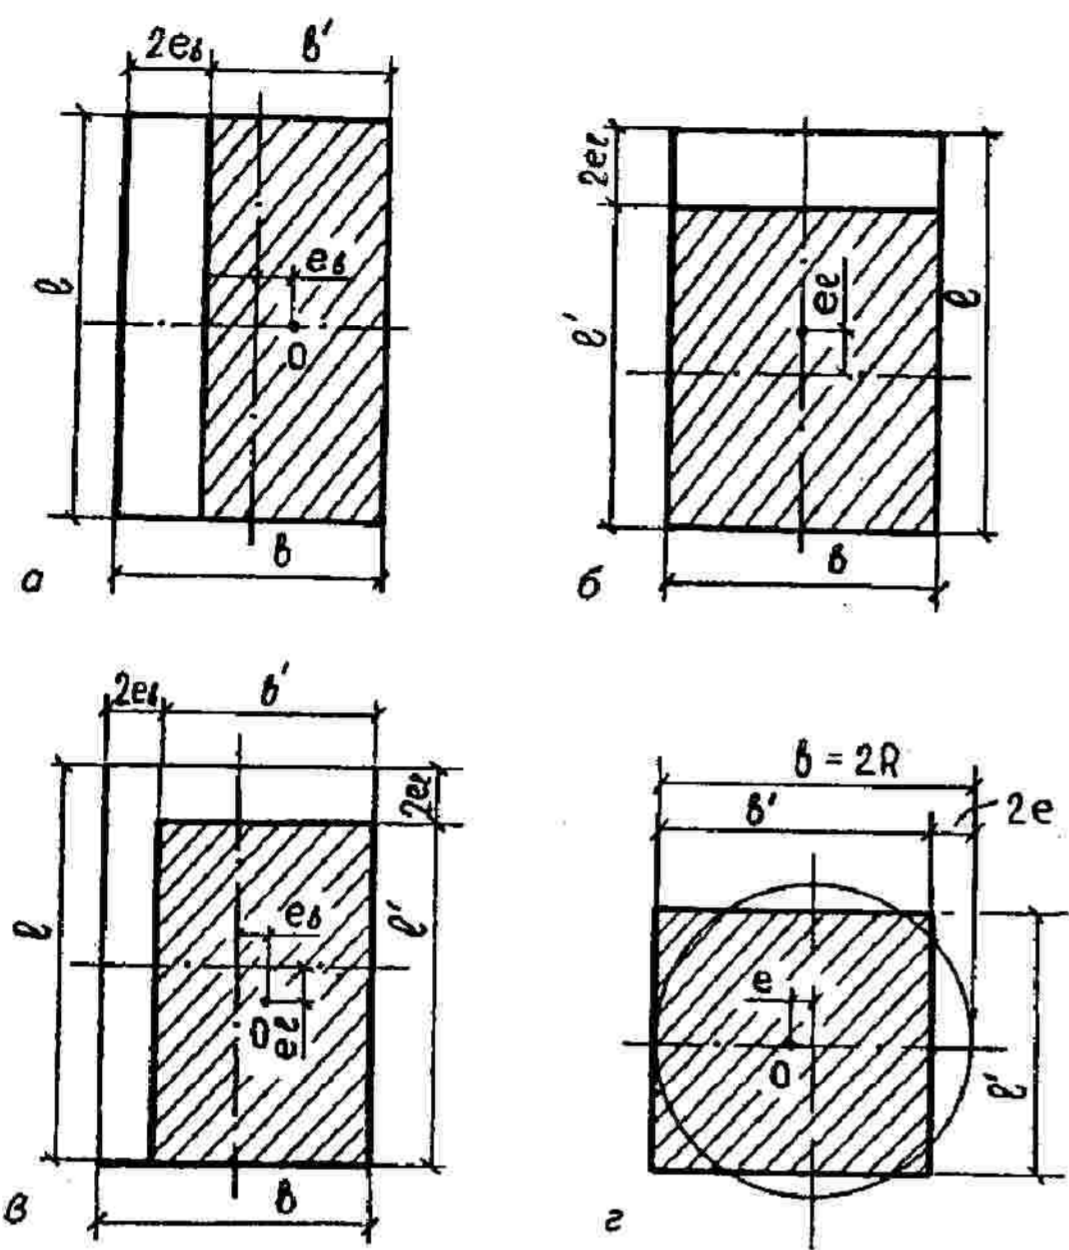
Схема к определению приведенных размеров подошвы фундамента:
